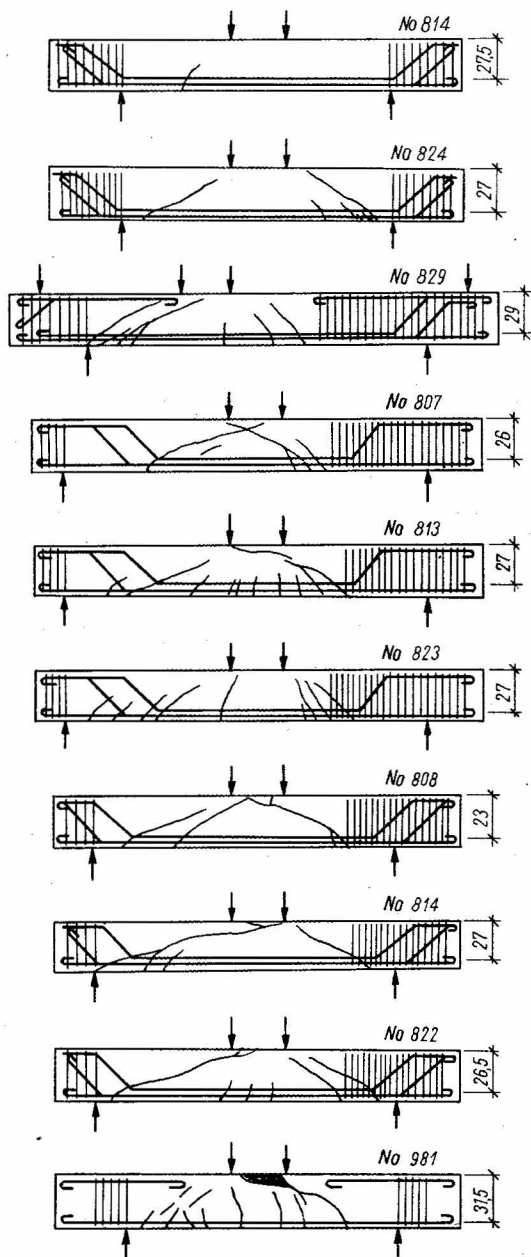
Poutres dans les essais de BORICHANSKI
